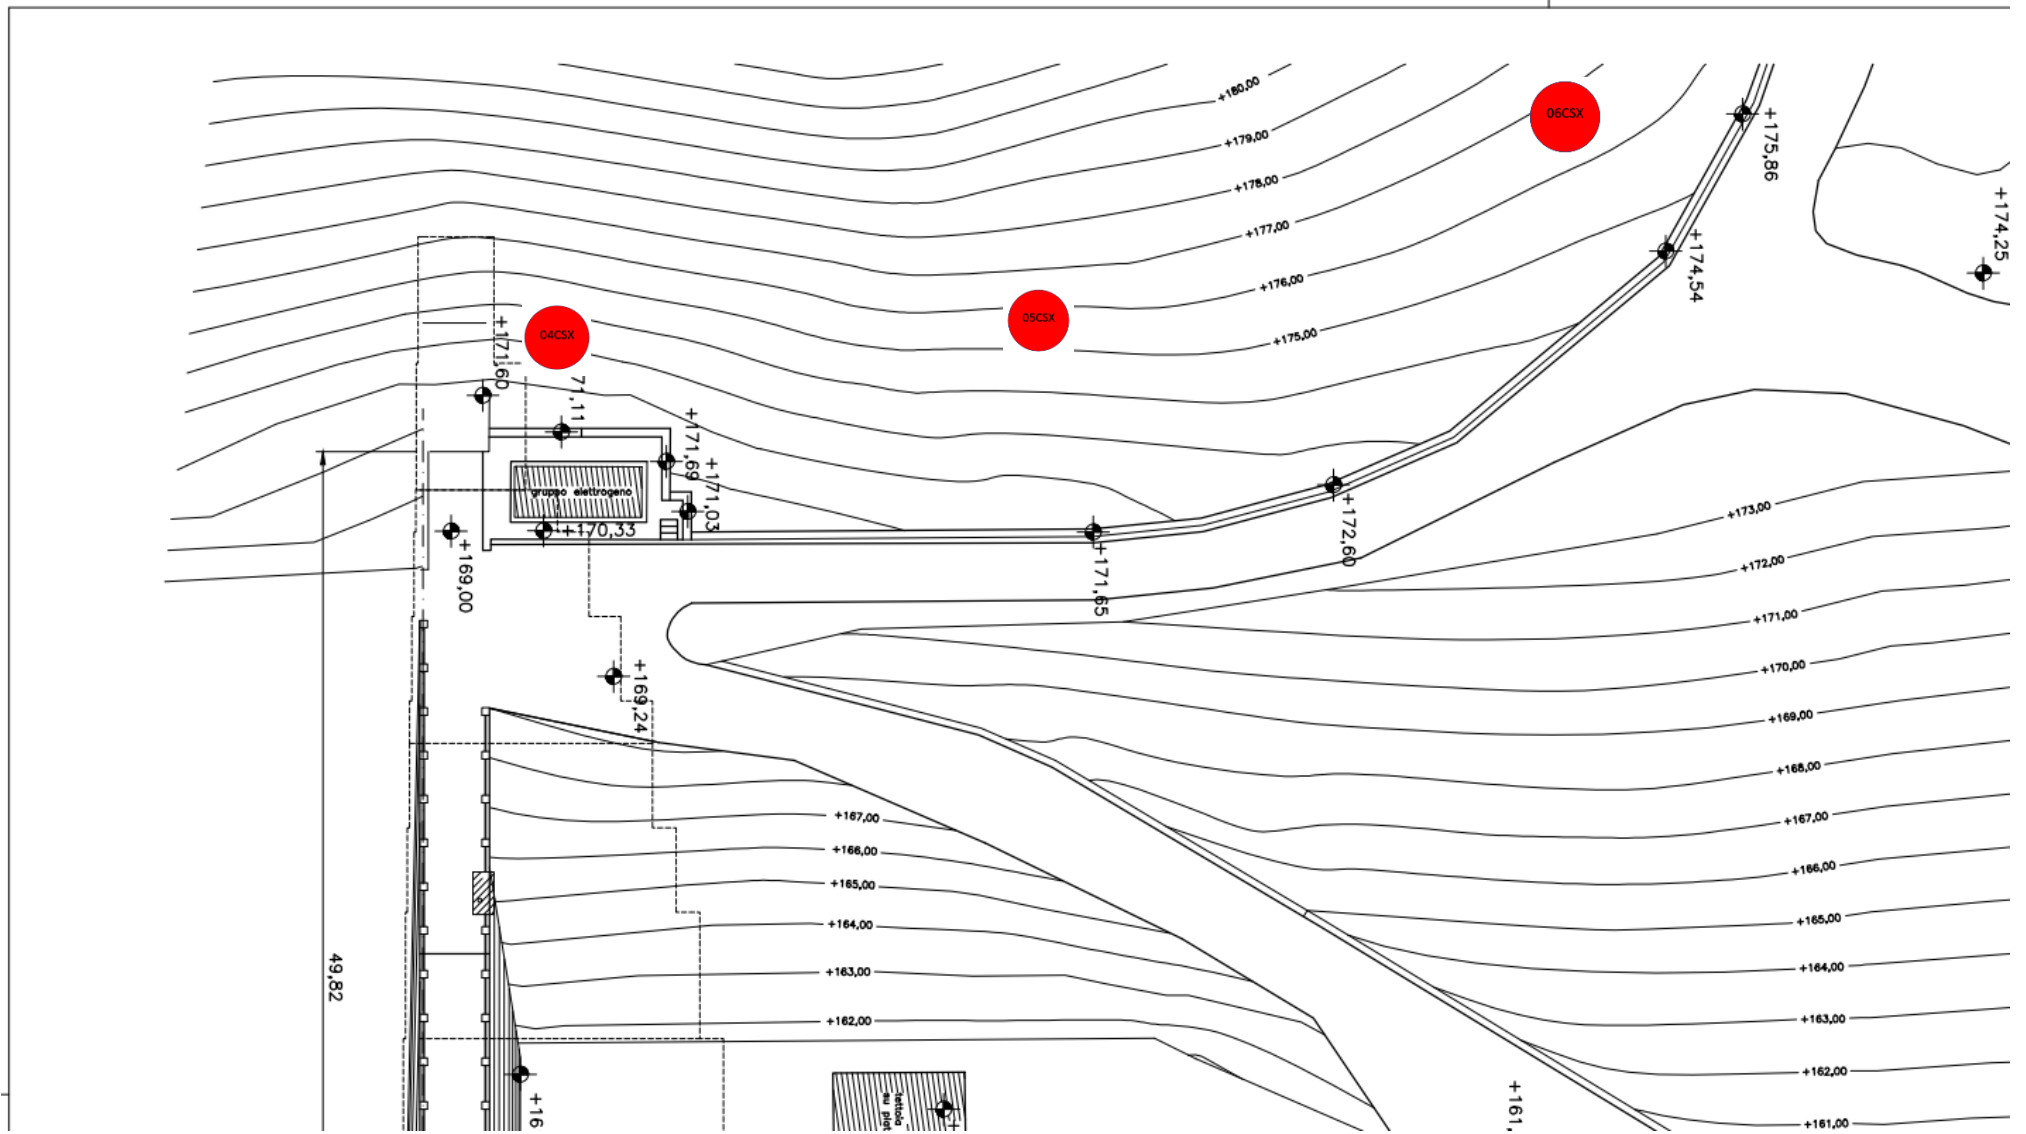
4 - INQUADRAMENTO PLANIMETRICO PUNTI CAMPIONAMENTO SPONDA SX
